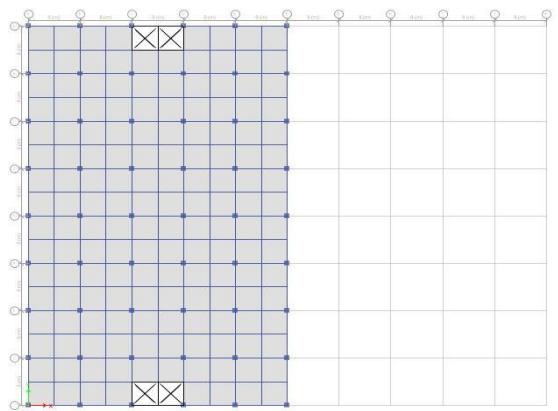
Denah Lantai 3 - Lantai 4 Model B1
